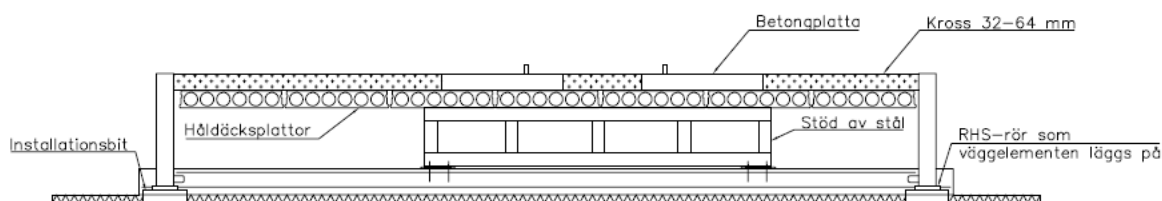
Skärning av trafon, bilden hittas som större i bilaga 7.
